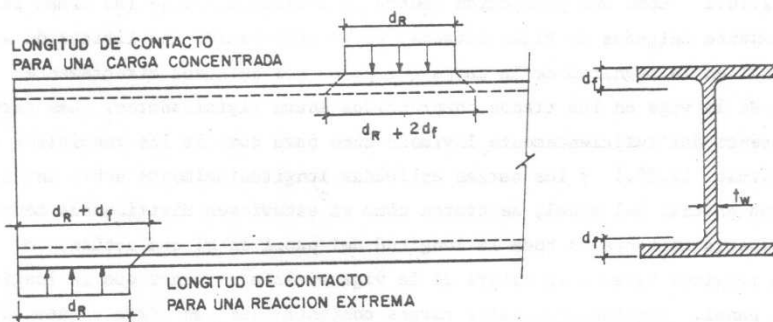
LONGITUDES PARA VERIFICAR EL APLASTAMIENTO LOCAL DEL ALMA EN VIGAS SIN RIGIDIZADORES TRANSVERSALES DE SOPORTE
